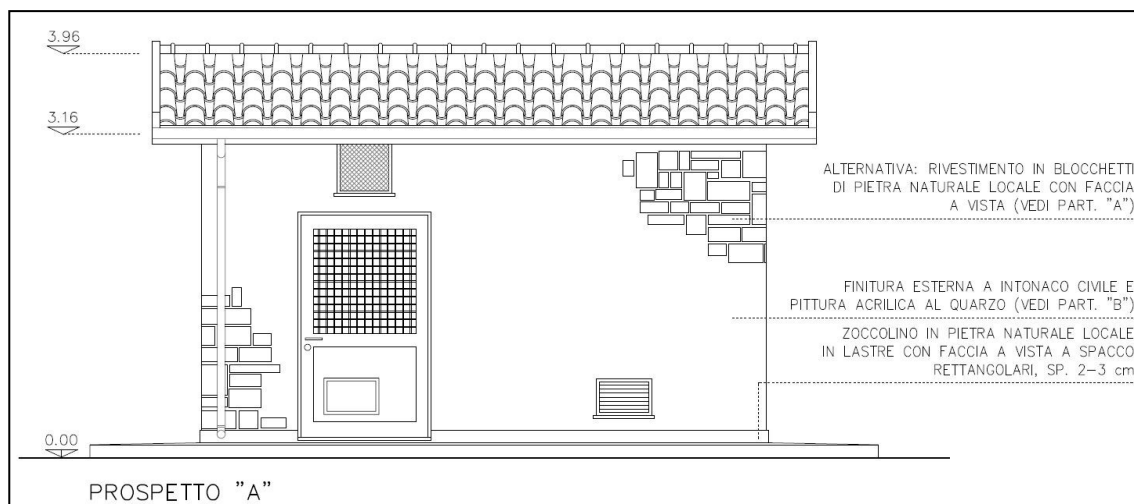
Edificio Tipo B5 – Prospetto "A" (riproduzione non in scala)
